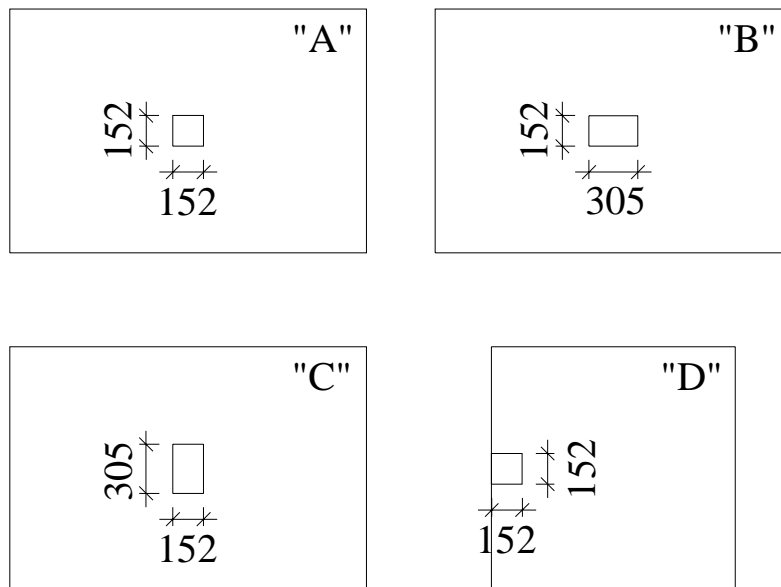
Configurações das lajes de HANSON & HANSON (1964) (mm)
